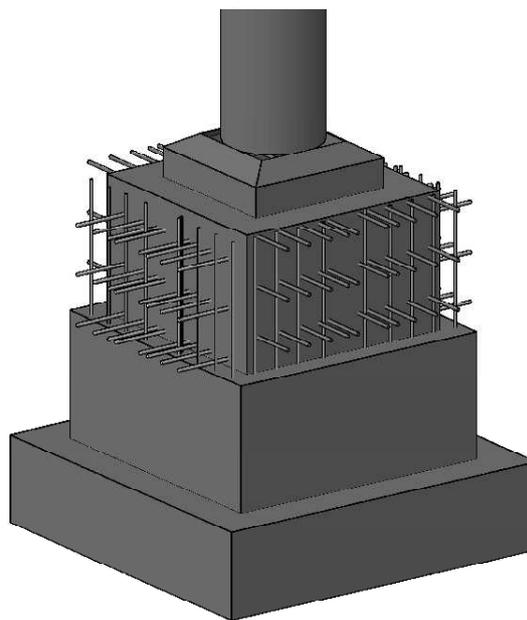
Заделка арматурных стержней в верхней части фундамента
